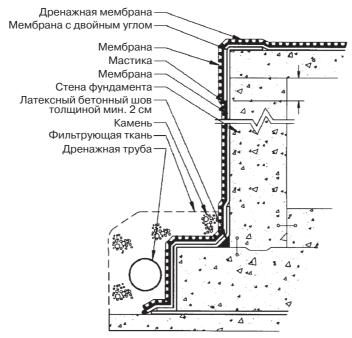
Гидроизоляция подземного туннеля с использованием как горизонтального, так и вертикального дренажа (предоставлено TC Mira DRI)
